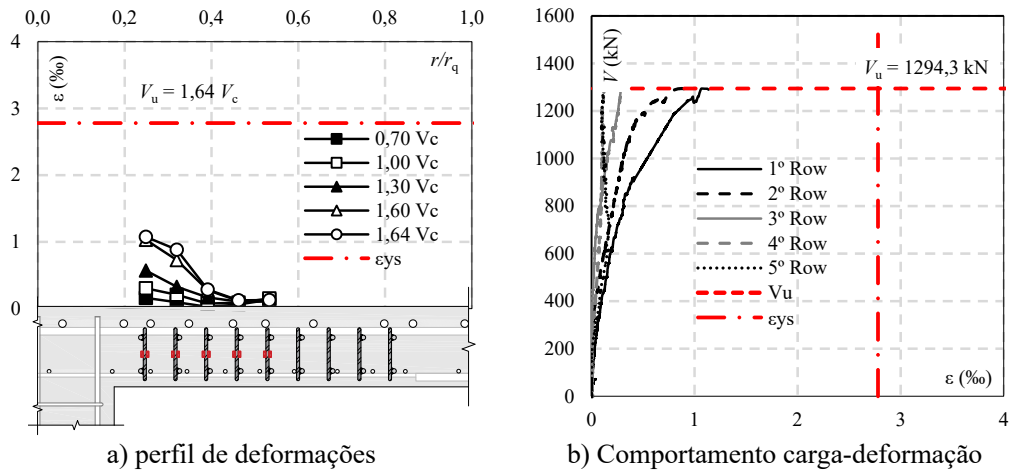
Deformações nas camadas de armadura de cisalhamento da laje SW1.
